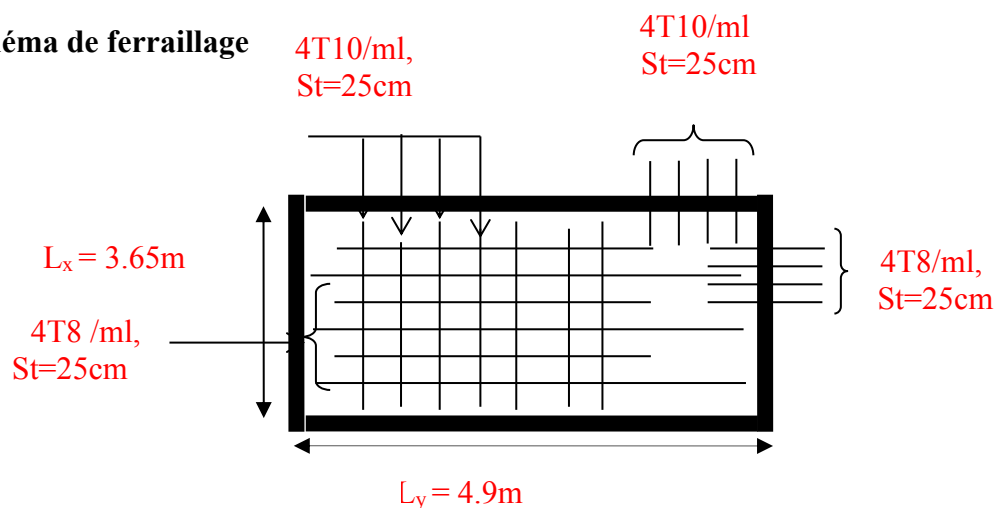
Schéma de ferrailage de la dalle sur 4 appuis.
